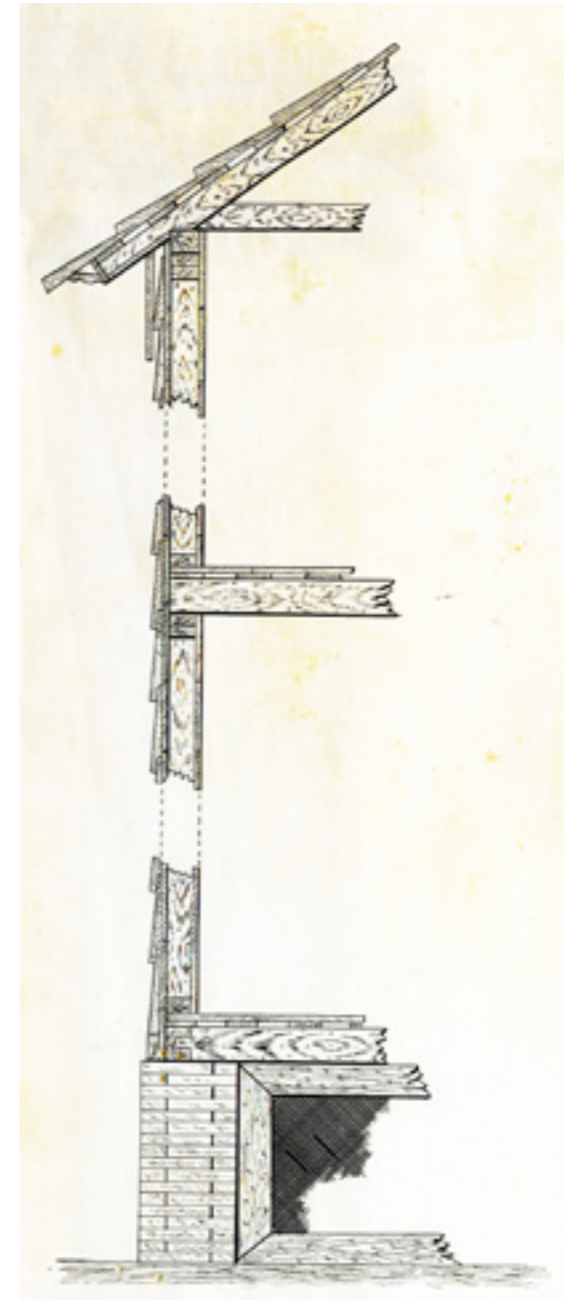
Detalle constructivo que muestra el uso de columnas de 12,5 x 12,5 cm de sección en un portal ensamblado.
